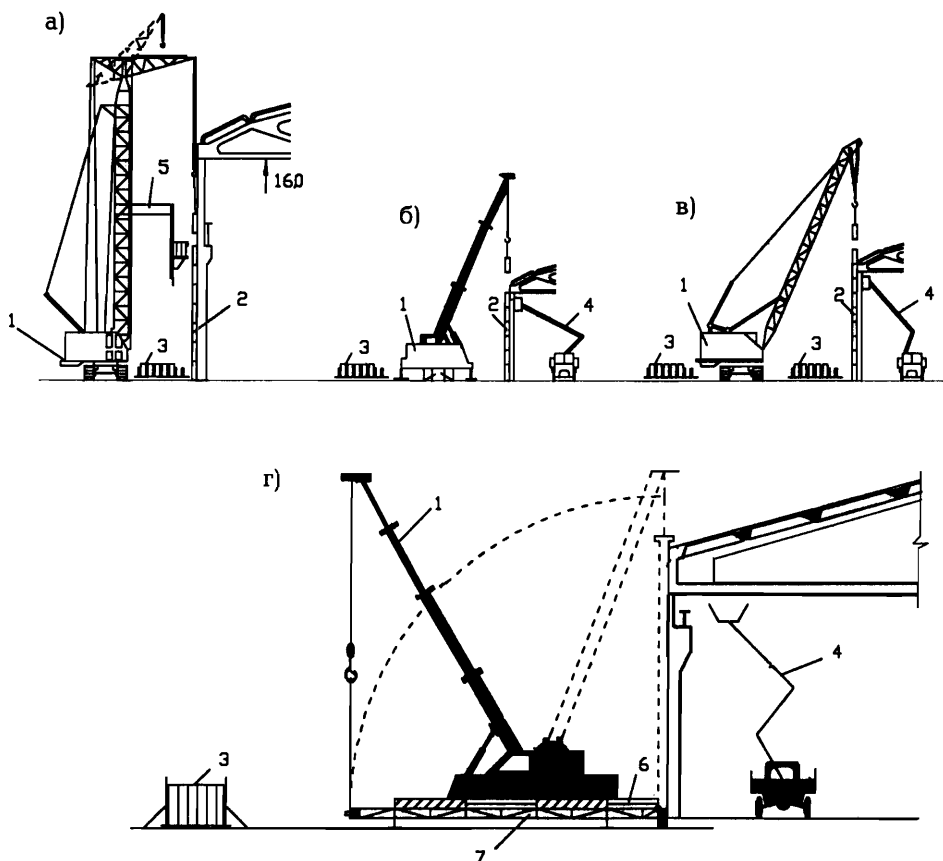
Технологические схемы монтажа стенового ограждения: а - специальным краном с подвижной площадкой; б - стреловым краном на пневмоколесном ходу; в - гусеничным краном; г - укрупненными панелями на высоту здания; 1 - кран; 2 - стеновая панель; 3 - кассета со стеновыми панелями; 4 - вышка с рабочей площадкой; 5 - консольная перемещаемая по башне площадка; 6 - укрупненная панель на высоту здания; 7 - кондуктор
